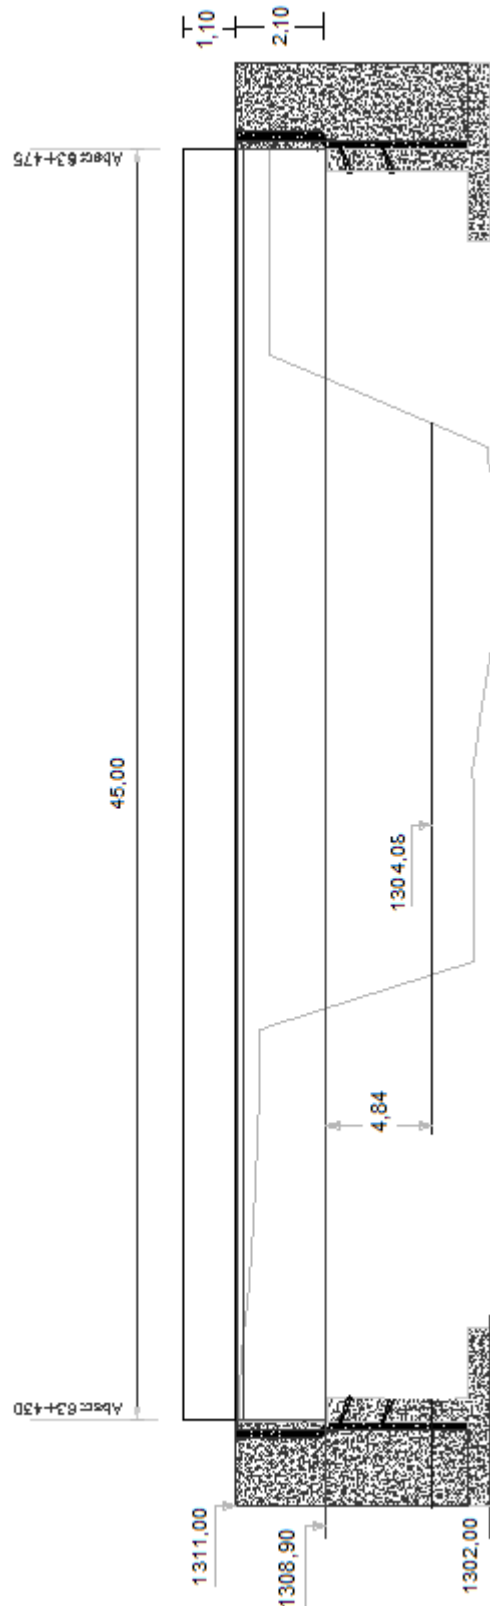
Elevación del puente vigas de hormigón pretensado y tablero de hormigón armado (alternativa “B”)
